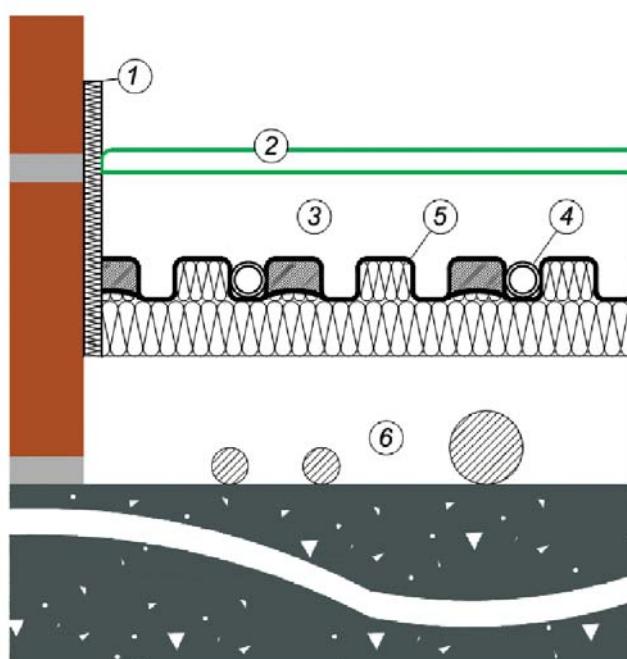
Конструкция теплого пола: 1 – демпферная лента; 2 – напольное покрытие; 3 – стяжка; 4 – труба теплого пола; 5 – профильный мат; 6 – бетонная плита
